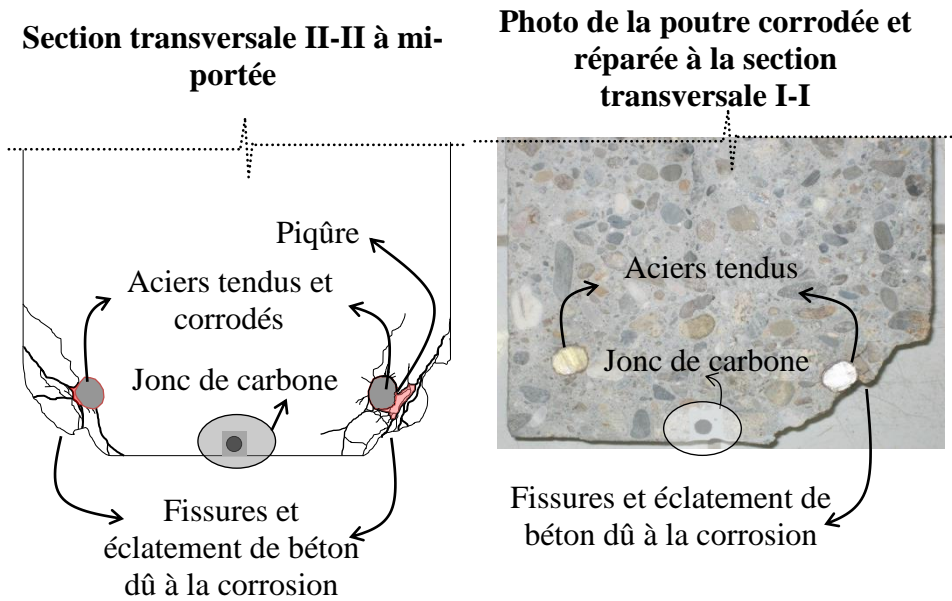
Position du jonc de carbone sur la surface tendue de la poutre B2CL1 (toutes les dimensions en mm).
